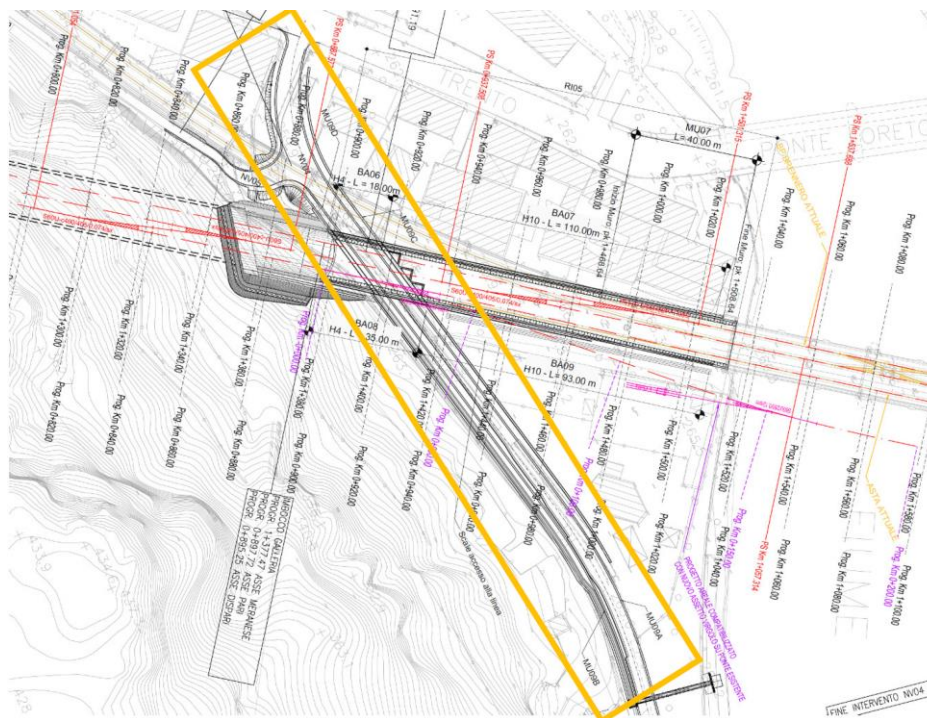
Planimetrica di progetto MU09 su viabilità NV04
